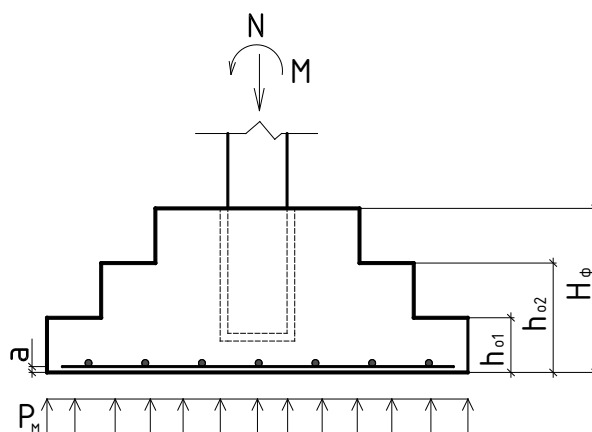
Схема фундамента и давление грунта в направлении короткой стороны подошвы фундамента (из плоскости действия изгибающего момента)
